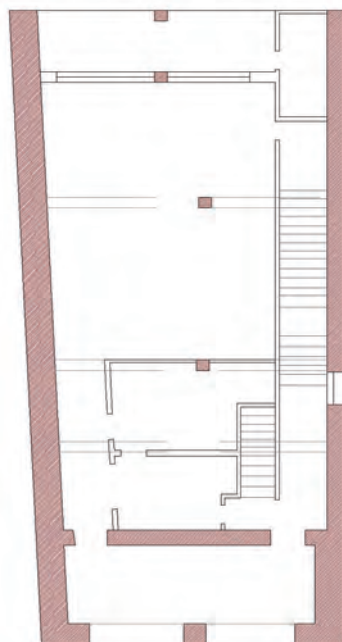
21. ESQUEMA ESTRUCTURAL EN PLANTA BAJA ANTES DE REFORMA FIGURA A18. 22. ESQUEMA ESTRUCTURAL EN PLANTA BAJA ACTUAL
